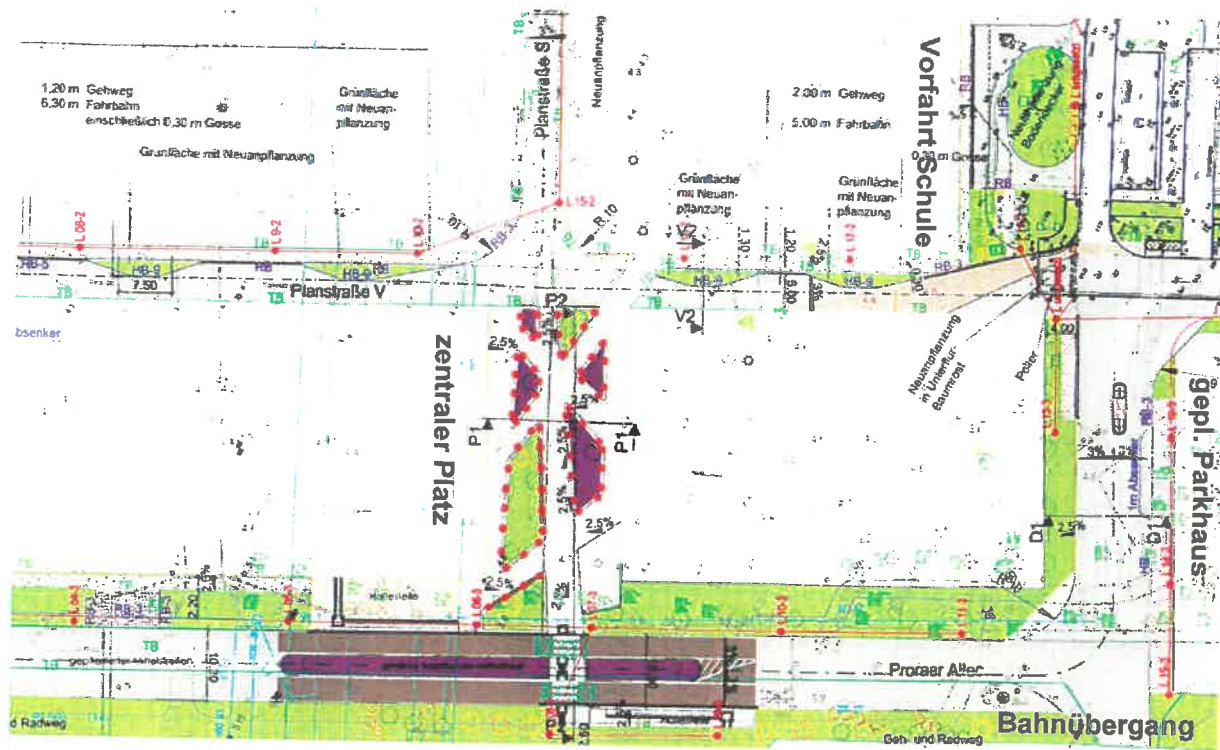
Genehmigungsplanung Erschließung, Ausschnitt zentraler Bereich ohne Maßstab, VIUS Ingenieurplanung & Co KG, Stand 08/2020
